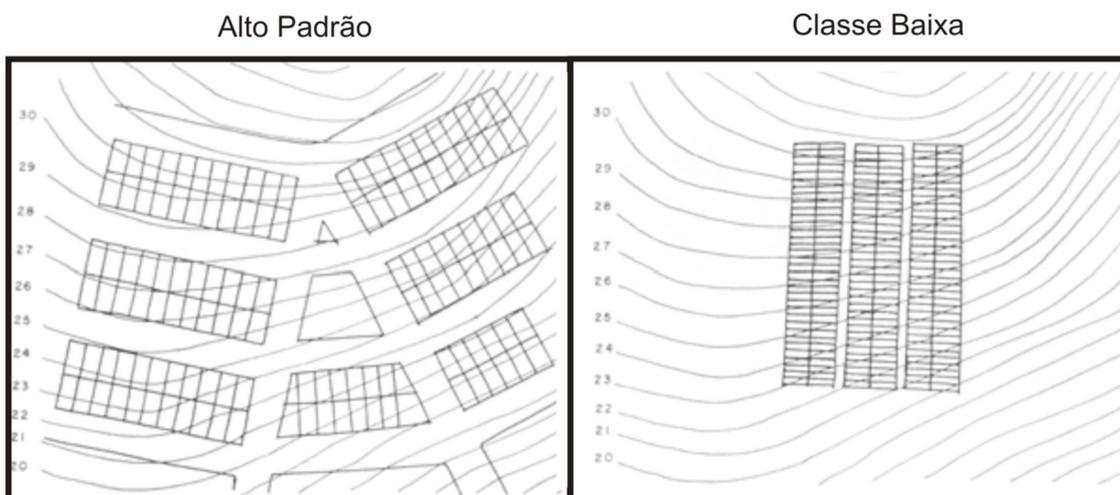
Implantação das ruas em loteamentos de alto padrão e de classe baixa.
